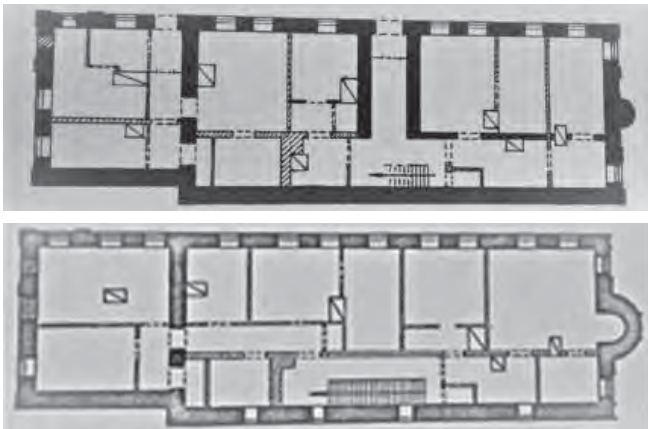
Планы 1 и 2 этажа здания мечети (1987 г.)
